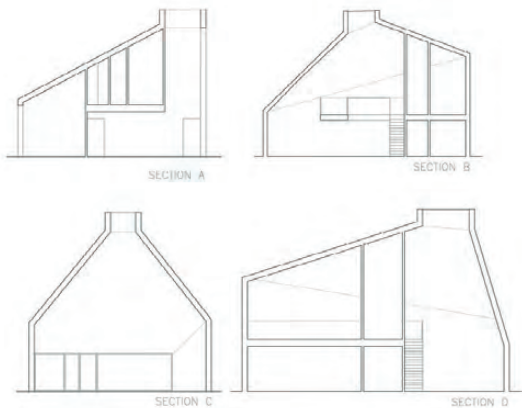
Alzados y Secciones (2010) / Figure 5. Elevations and sections (2010).
